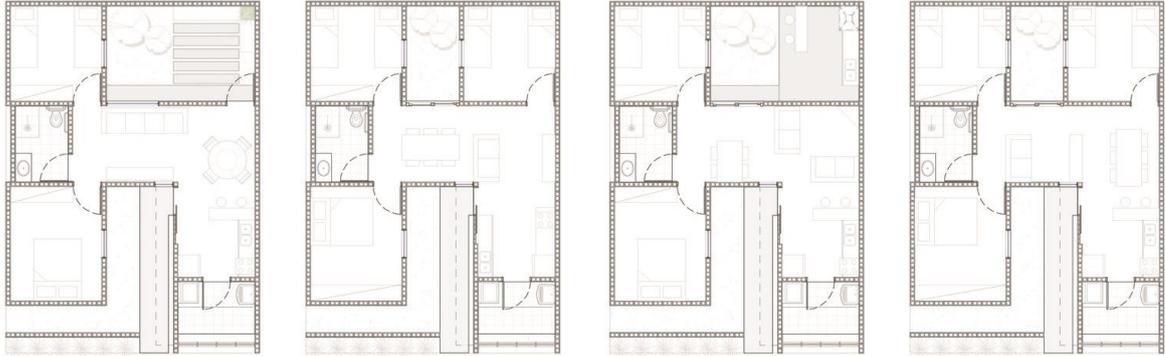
Plantas do projeto de 24.7 Arquitetura.
